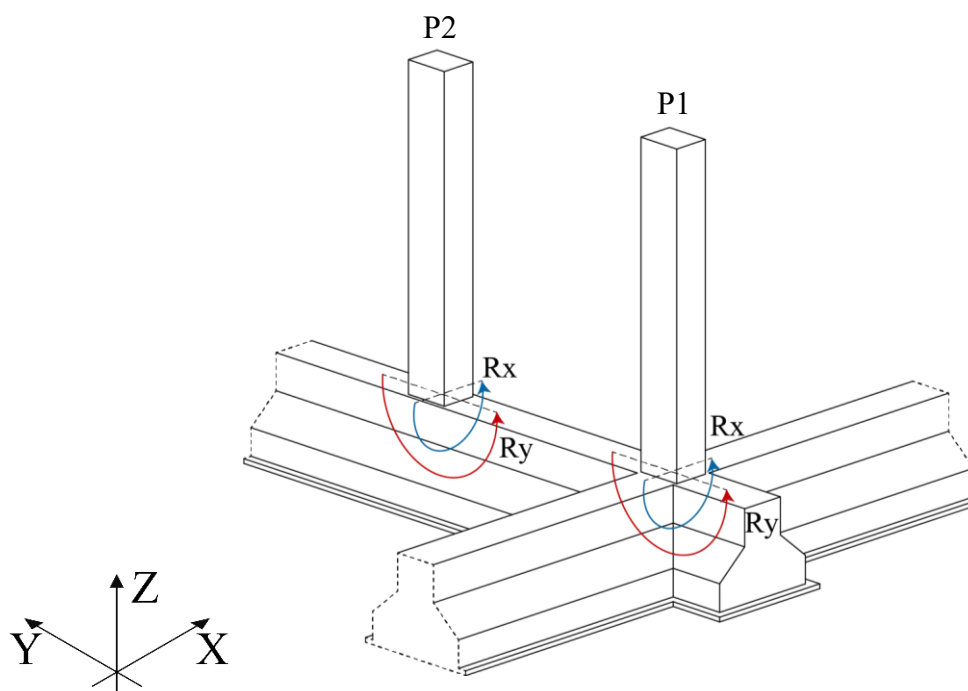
Rappresentazione del concetto di condizione geometrica.
